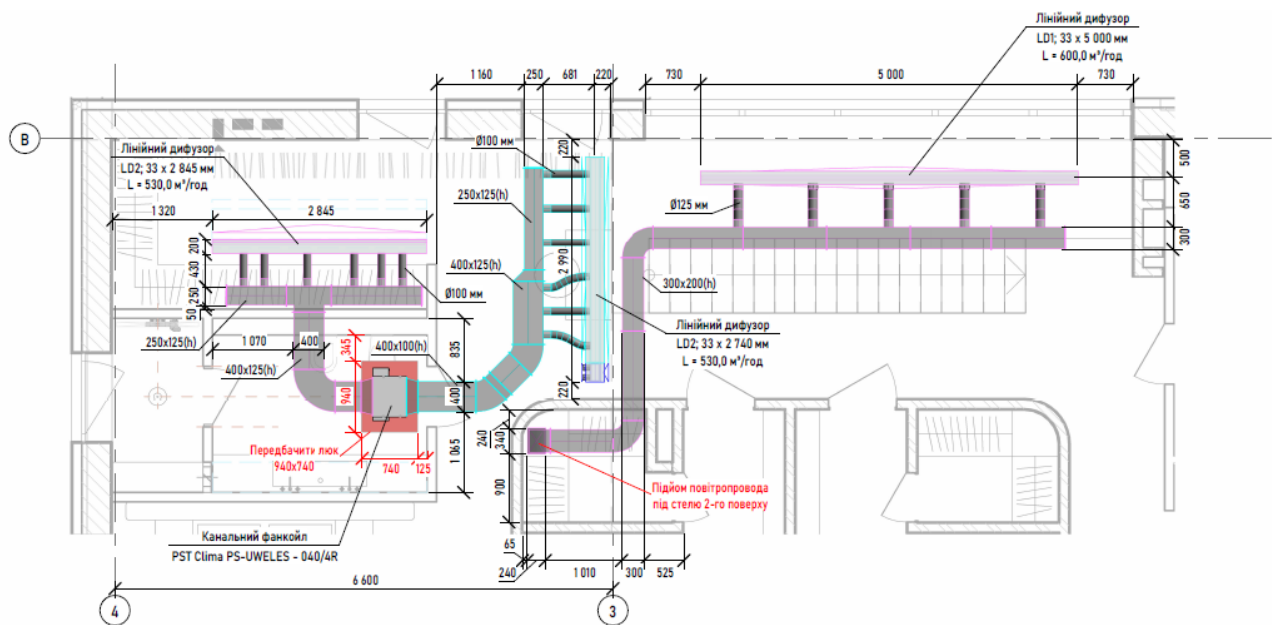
Система охолодження фанкойлами. План 2-го поверху.
